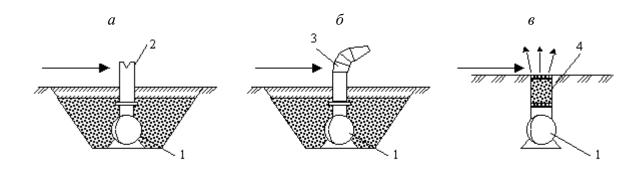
Оголовки рассеивающих выпусков a-c конусным растекателем; $\delta-c$ отводом и соплом; s-без насадки 1- распределительный трубопровод; 2- растекатель; 3-сопло; 4-гравийная засыпка
